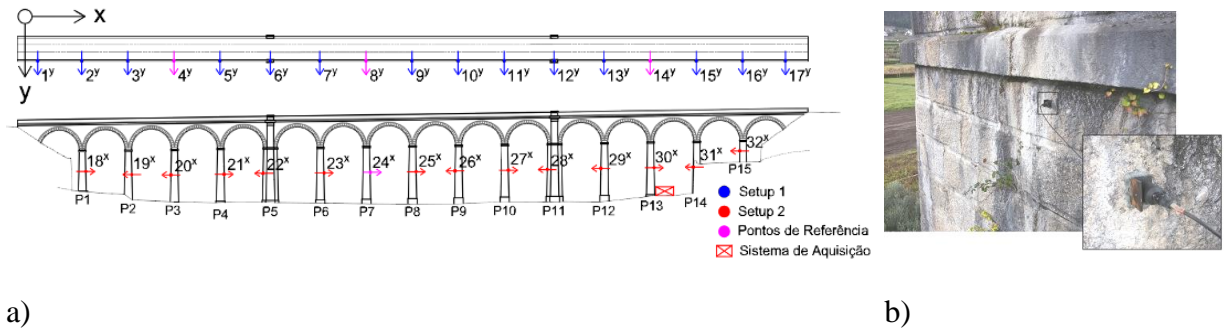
Ensaio de vibração ambiental da ponte do Côa: plano e planta com os pontos de medição.
